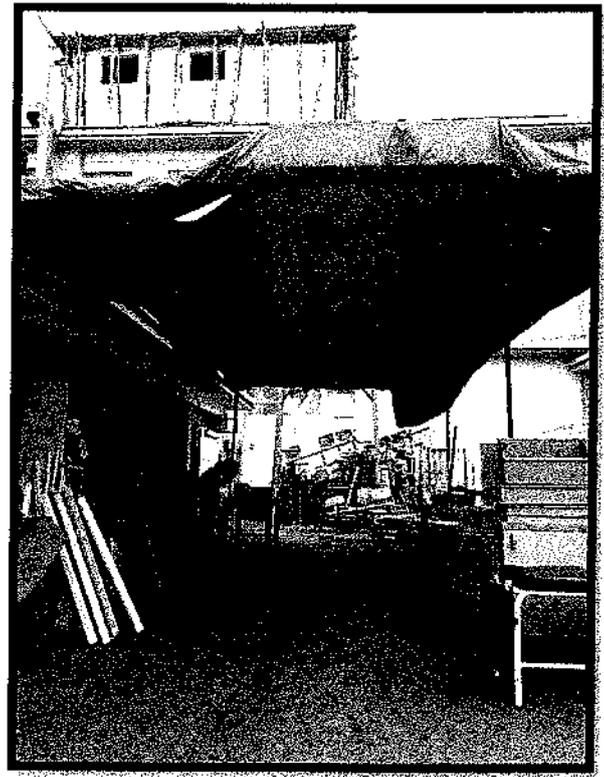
COBERTURA DETERIORADA – ZONA DE SILLAS DE RUEDAS EN EL INGRESO DE LA PUERTA N°02 HACIA EMERGENCIA.
